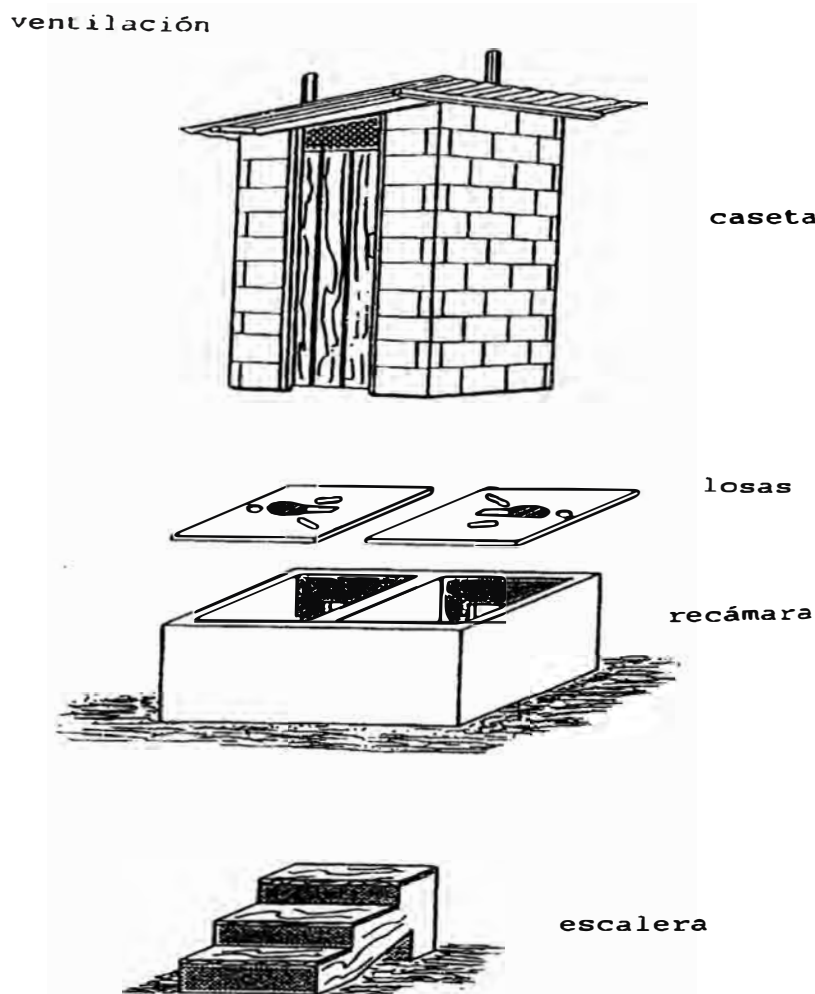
Componentes de la letrina de recámara seca ventilada elevada – doble cámara.
